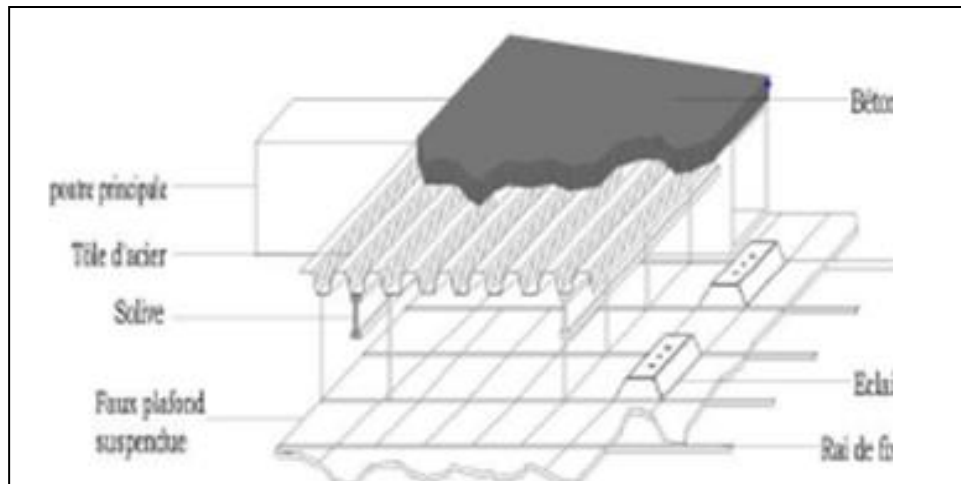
détail de plancher collaborant./Source : les auteurs.
